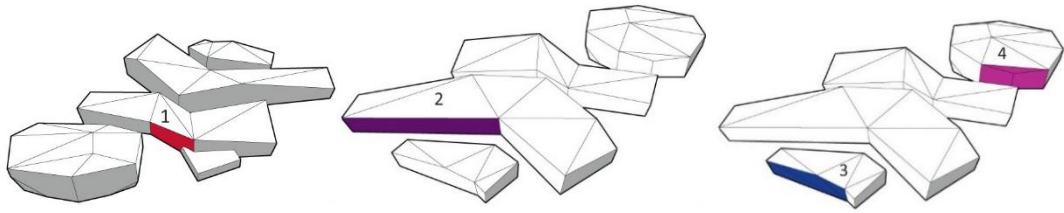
Konsep elemen facade bangunan poin 3 dan 4
